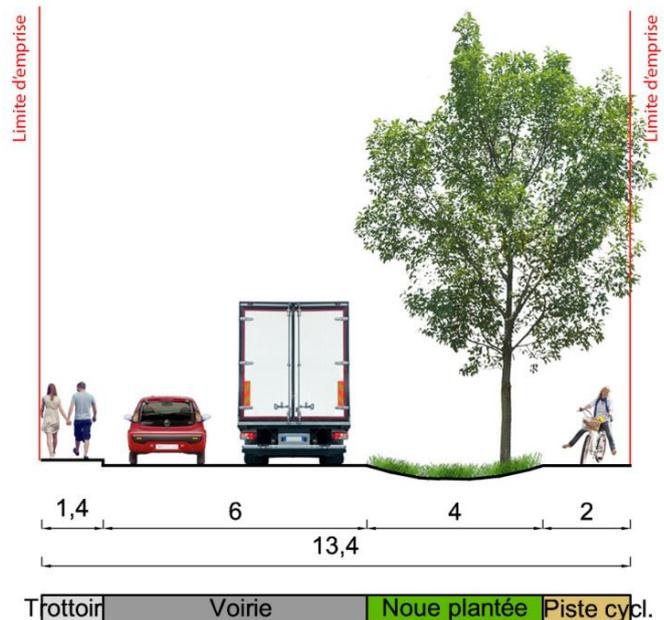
Profil type des voies tertiaires : profil 1 : avec trottoir et piste cyclable
